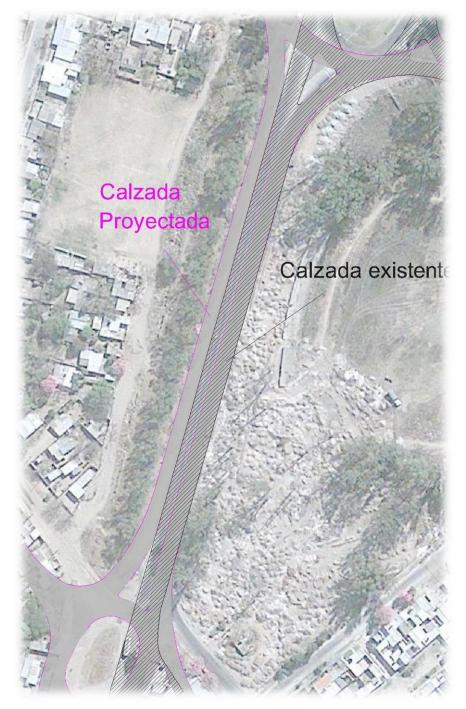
Tramo final donde Av. Lugones Norte se empalma con calle Hipólito Yrigoyen existente (sombreada a rayas).
